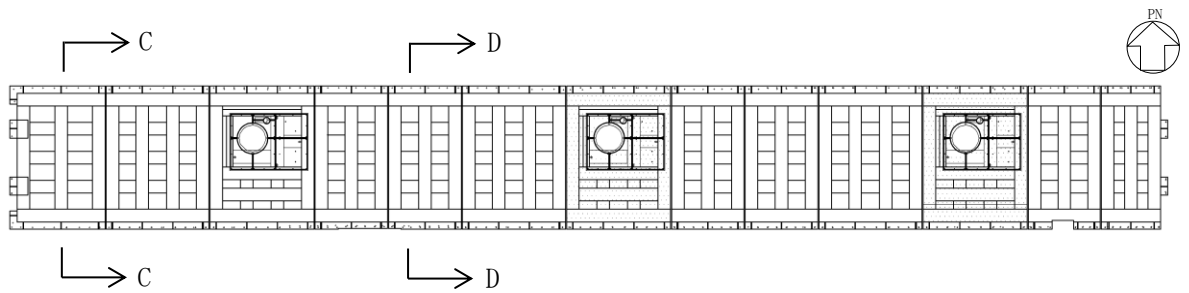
(3) 取水槽循環水ポンプエリア防護対策設備 平面図 (b 部詳細図)
